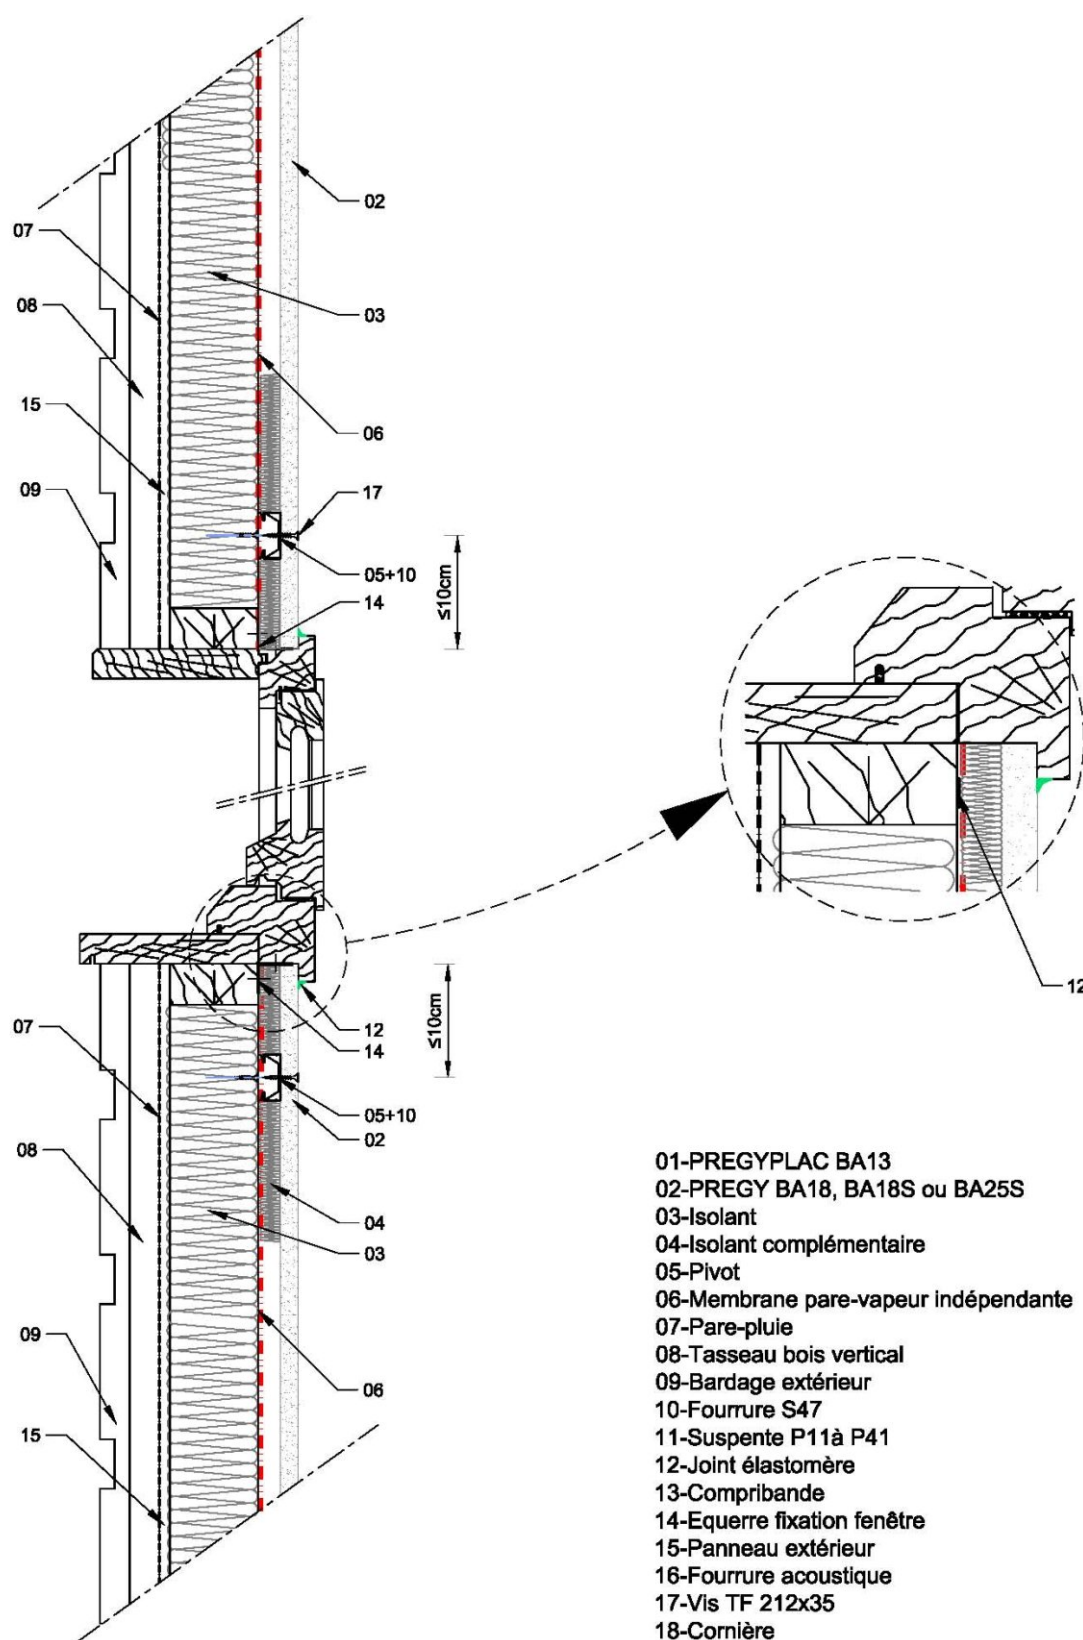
jonction avec menuiserie - Coupe verticale sur façade à ossature bois
